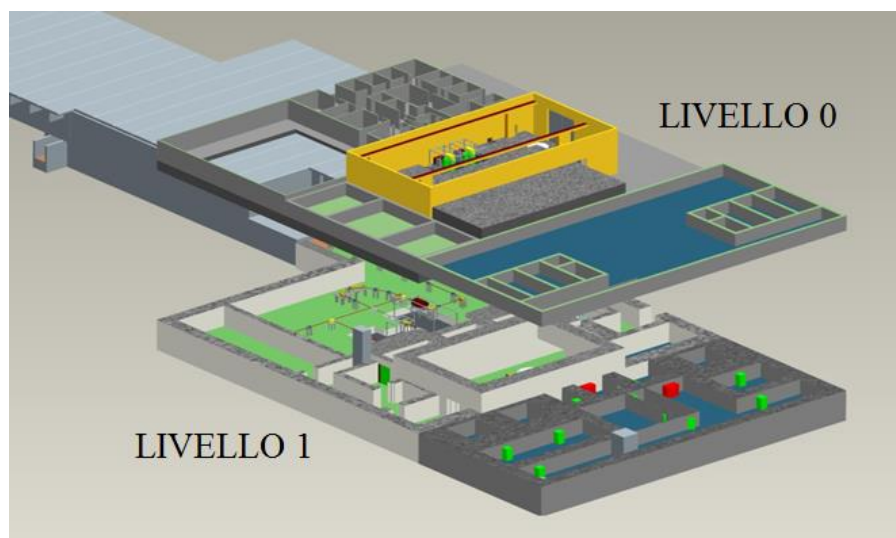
layout del progetto SPES (RIB e Neutron facilities).
